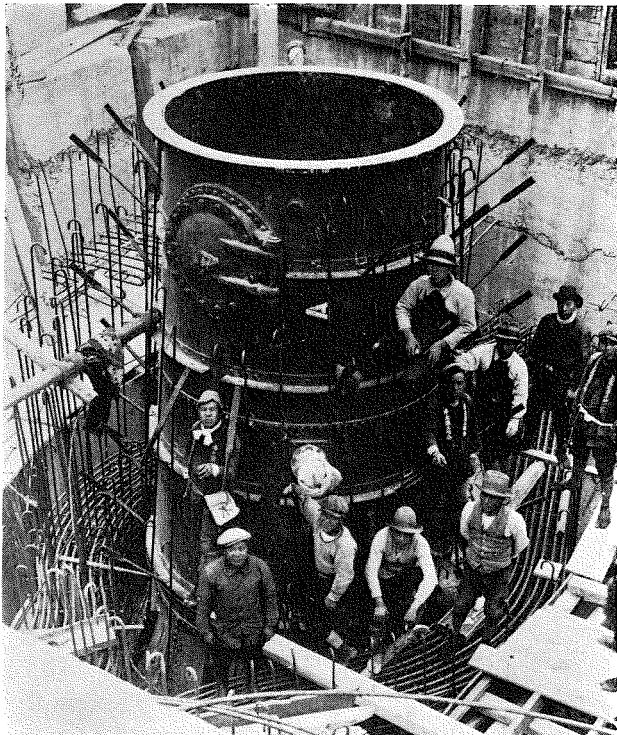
ドラフトチューブ周囲の鉄筋コンクリート。
